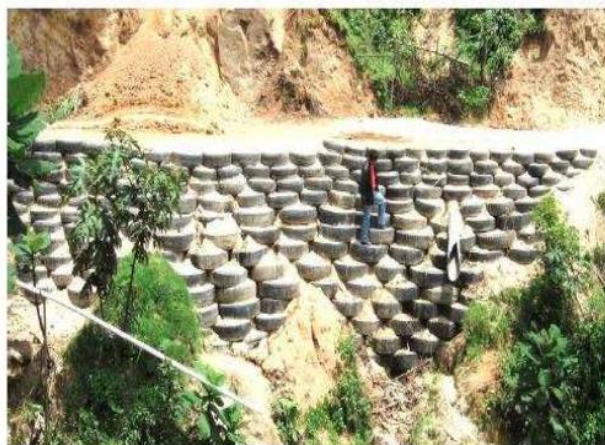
Ejemplo de relleno de llantas para la construcción de muros.
